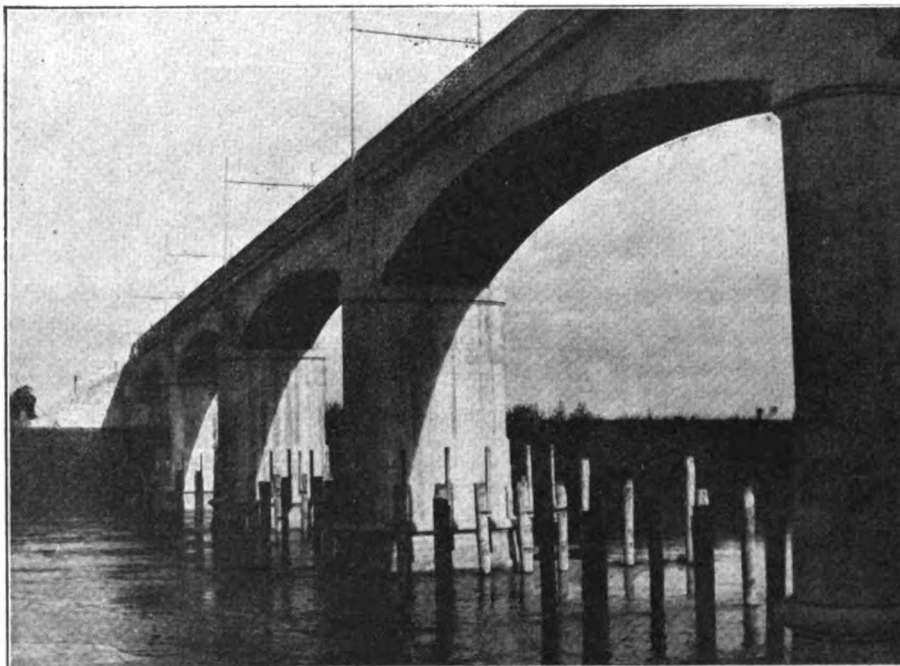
Ponte sul Tevere Vista della sottostruttura delle travate.
